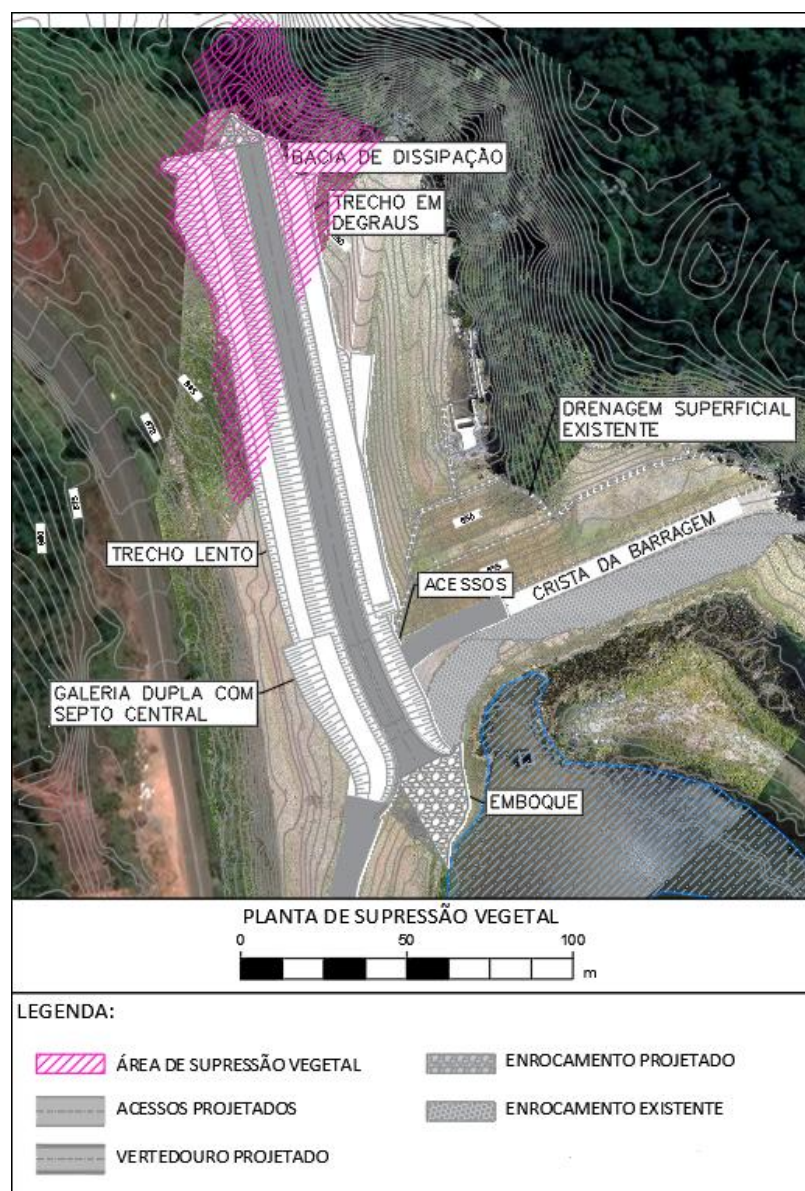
Planta de Supressão Vegetal para Implantação do Vertedouro. Fonte: 1850EE-X-83719 (CGF-E-BQ-DE-303)
